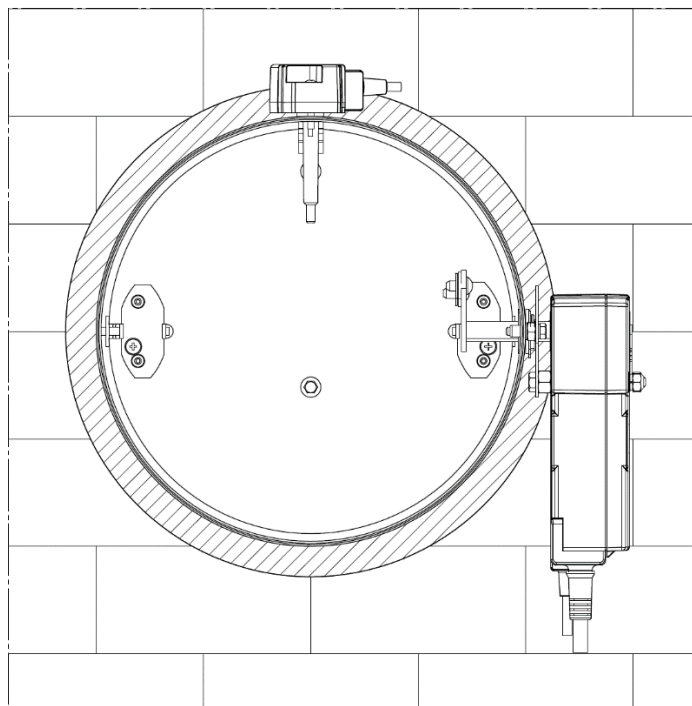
Sposób zabudowy kłap odcinających KTM w konstrukcjach stropowych
